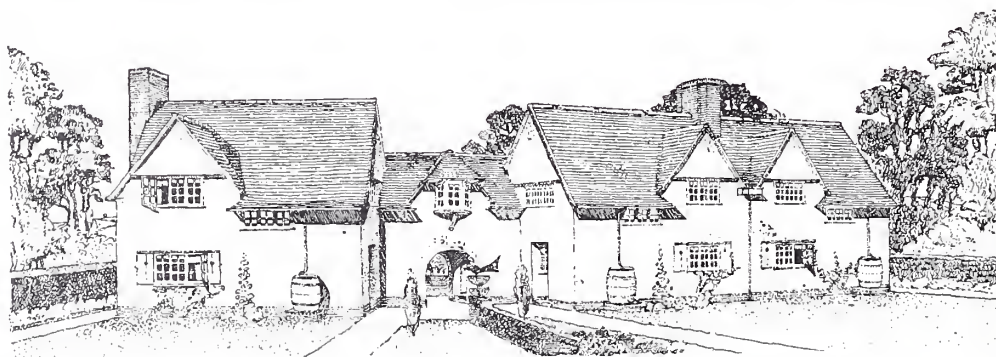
Garden Suburb Hampstead. Dreihäusergruppe in Temple Fortune Lane, Architekten Barry Parker und Raymond Unwin
